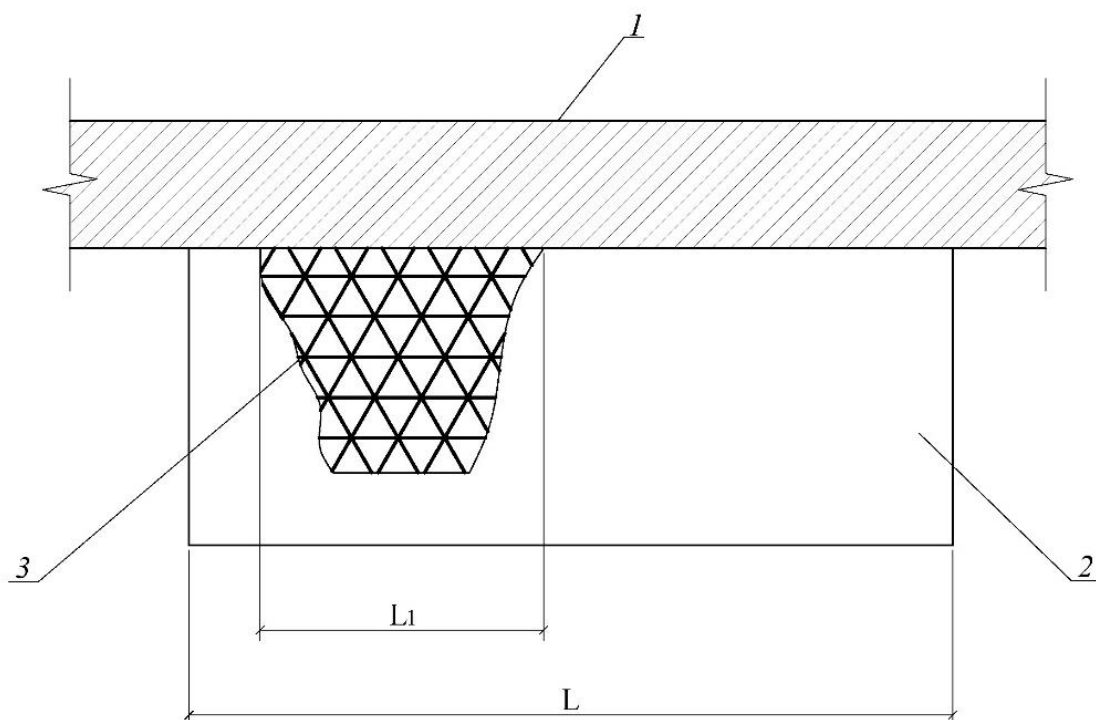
Схема дефекта - отслоение защитного слоя железобетонной балконной плиты в растянутой зоне (вид сверху): 1 – вертикальная несущая конструкция (стена); 2 – балконная плита; 3 – зона отслоения защитного слоя; L – длина балконной плиты (длина заделки), м; L_1 – длина зоны отслоения защитного слоя, м L_1 на a , L на l
